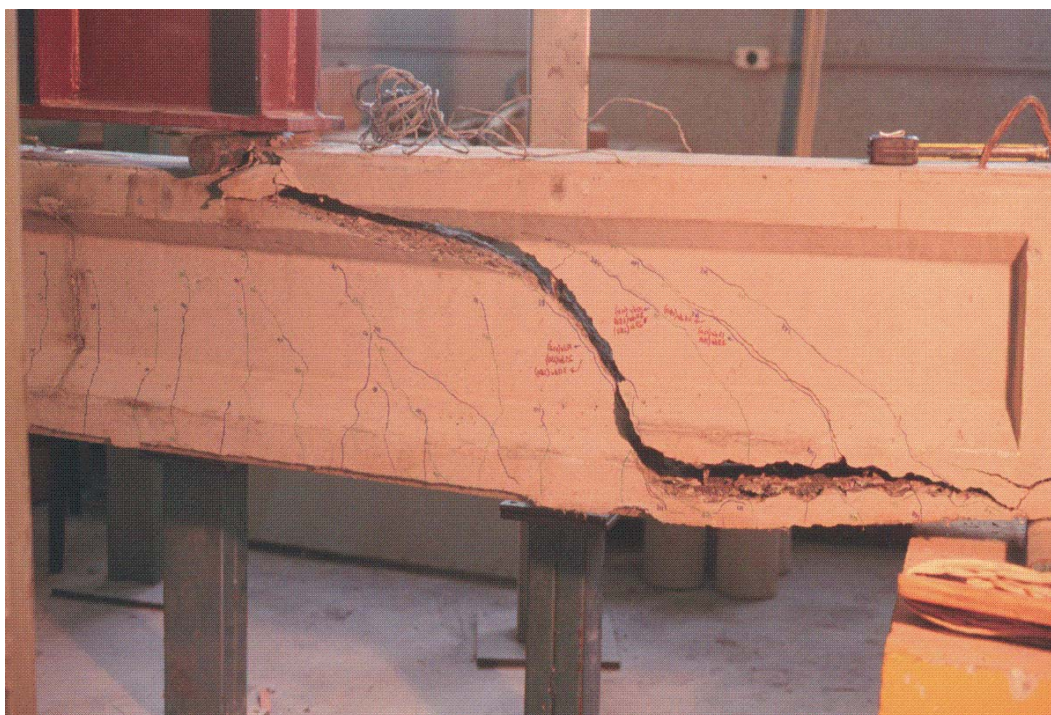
Viga V5A – Detalhe da viga após a ruptura
